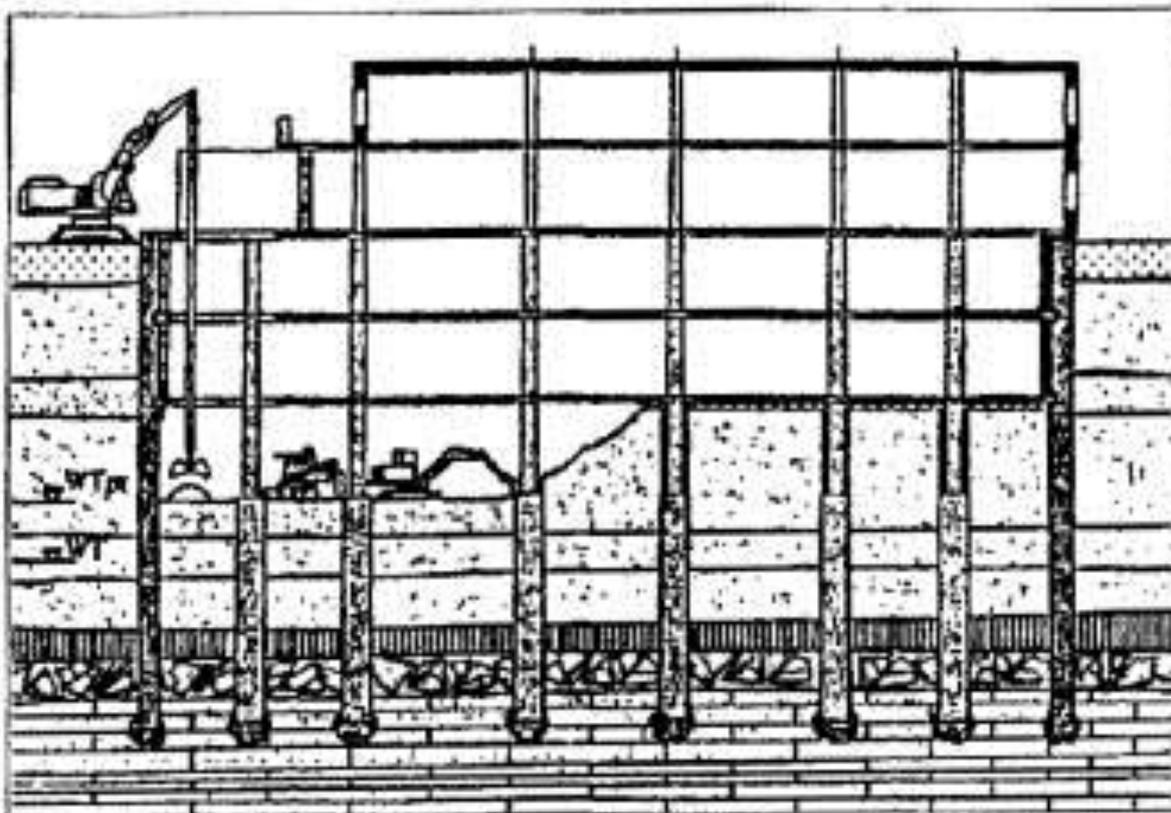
удаление грунта из-под бетонного перекрытия
